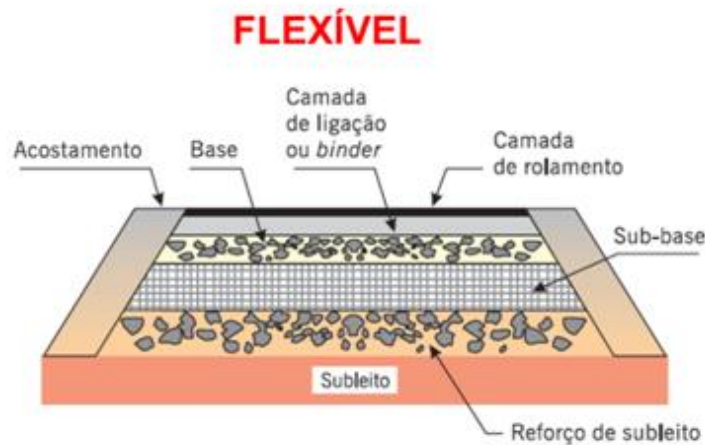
Corte transversal de pavimento asfáltico flexível.
